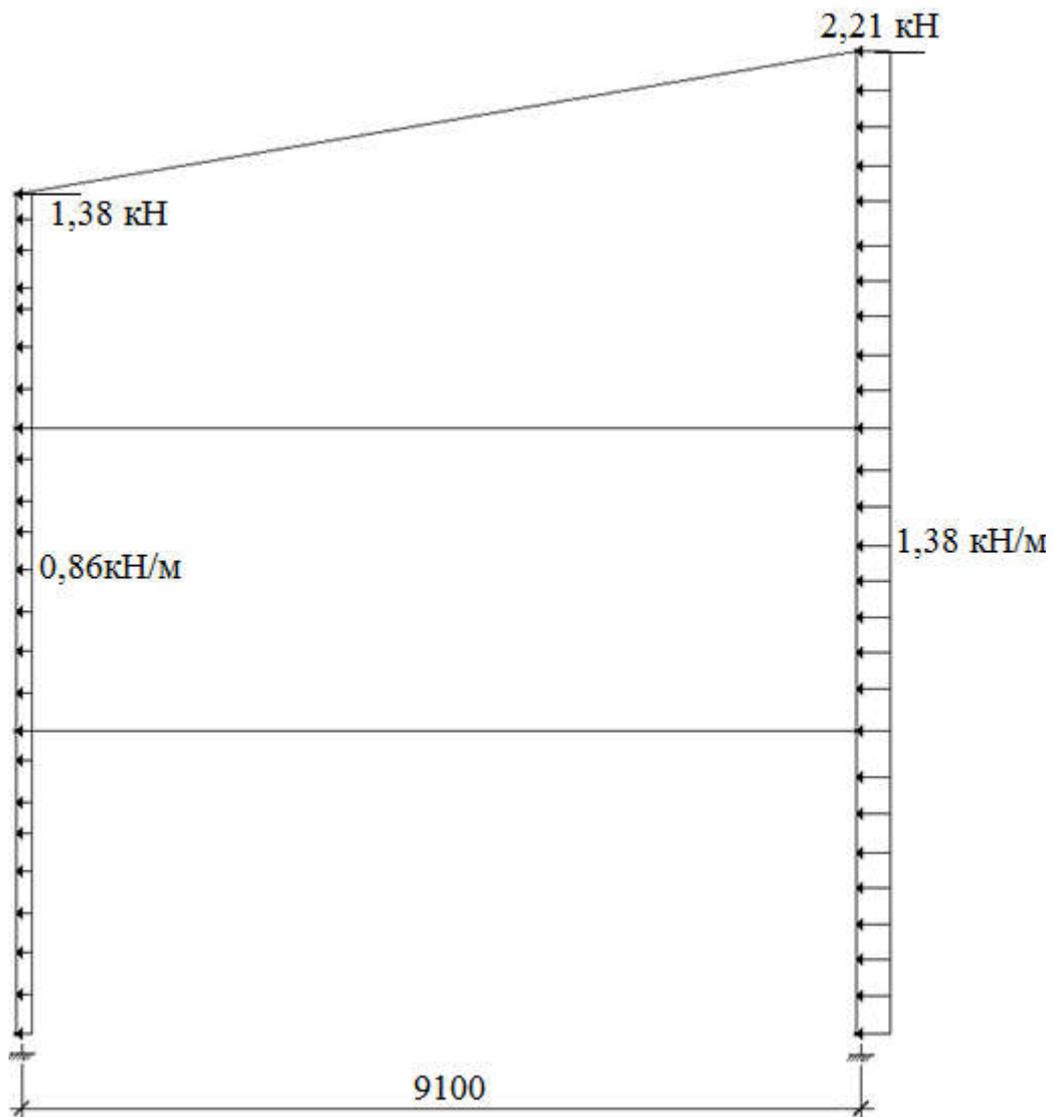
Схема загрузки от ветровой нагрузки справа здания
